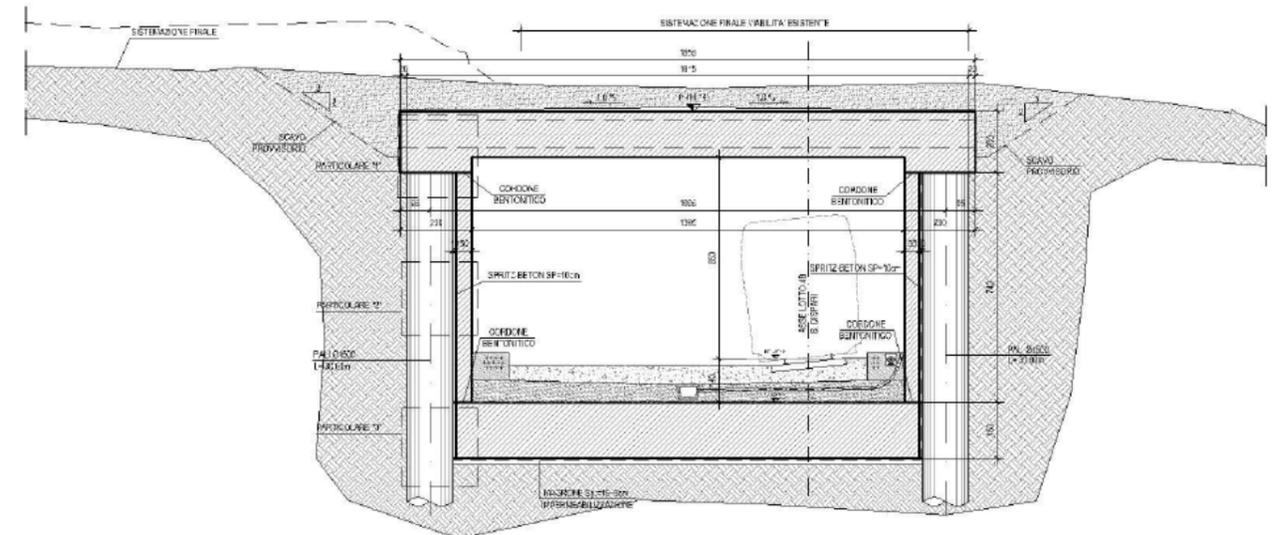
Sezione in allargamento della Galleria Artificiale GA01
